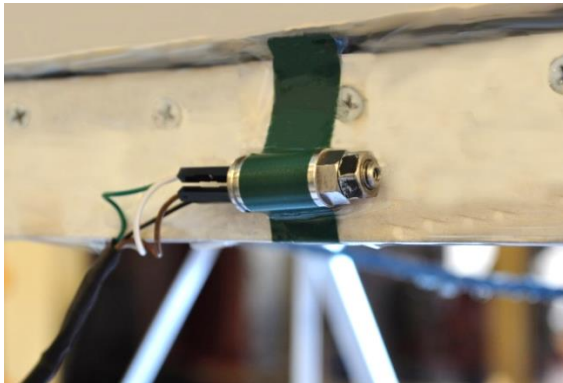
Fotografía de acelerómetro inductivo, ubicado en entrepiso de madera del modelo de perfilera metálica.
